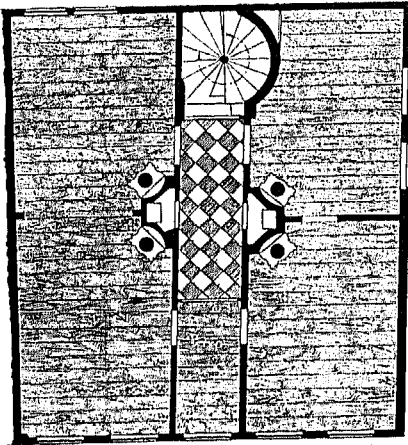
Vogel Strauss; Grundriss des I. Obergeschosses.
